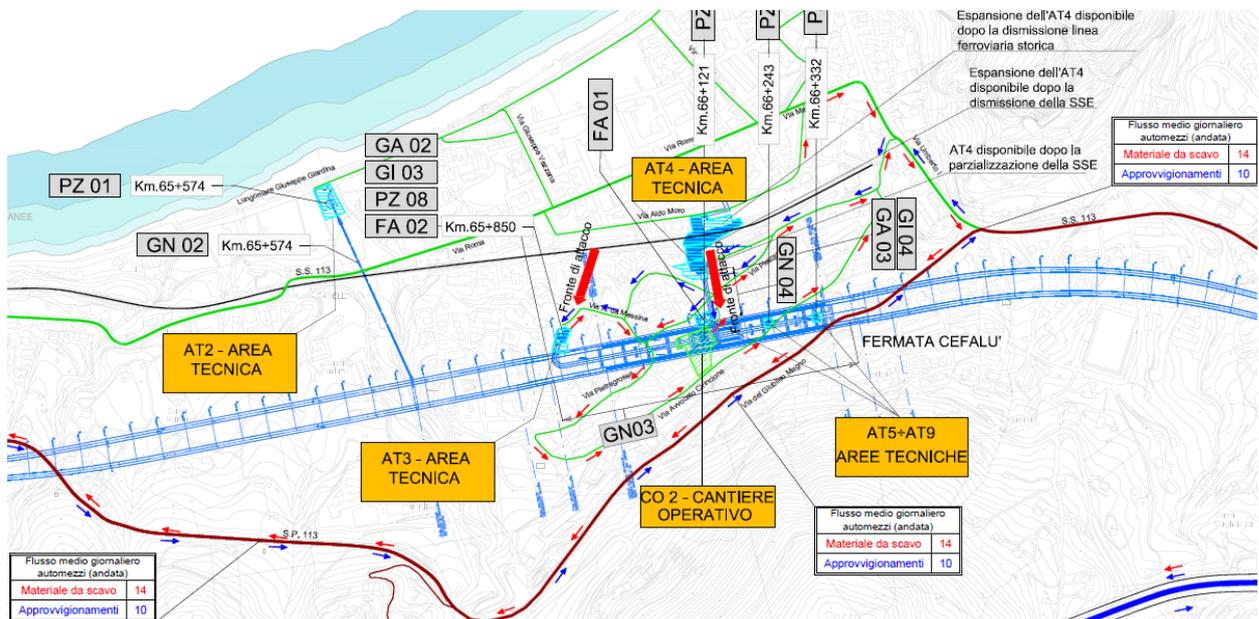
Periodo transitorio. Stralcio planimetria dei flussi area Stralcio Cefalù
